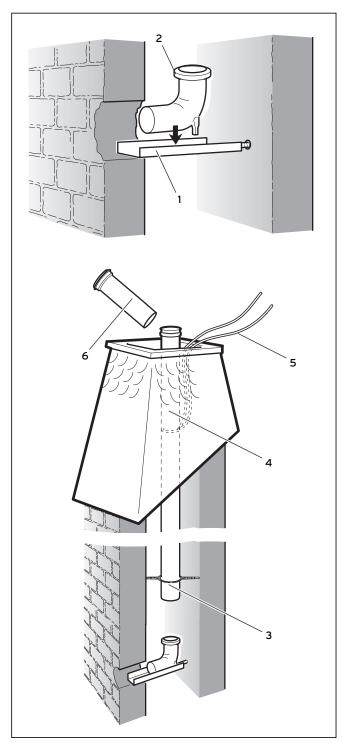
Монтаж опорной планки и опорного отвода, установка труб дымохода в шахту
